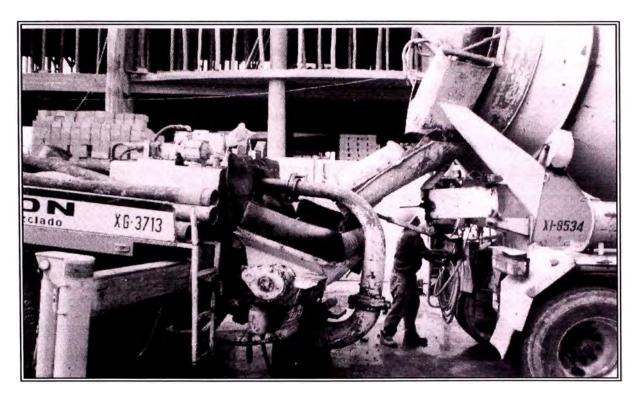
Camión concretero de 8 m3 y bomba de impulsión de concreto premezclado (120 HP)
